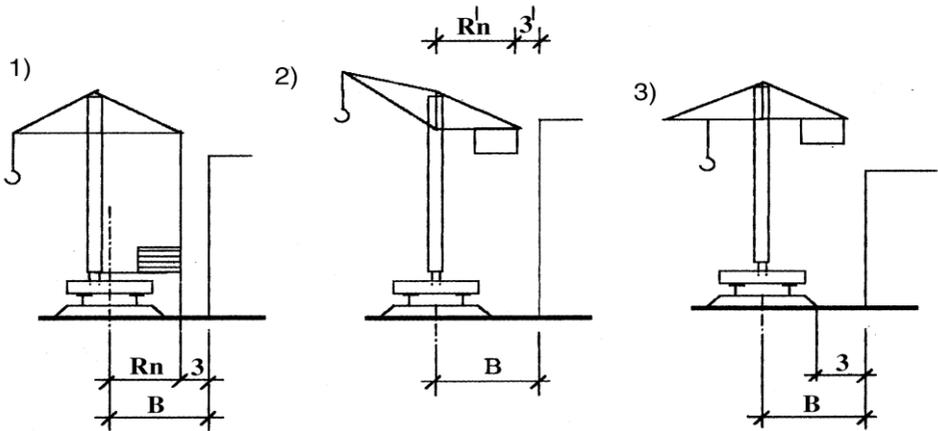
Схема привязки подкрановых путей башенного крана у здания
